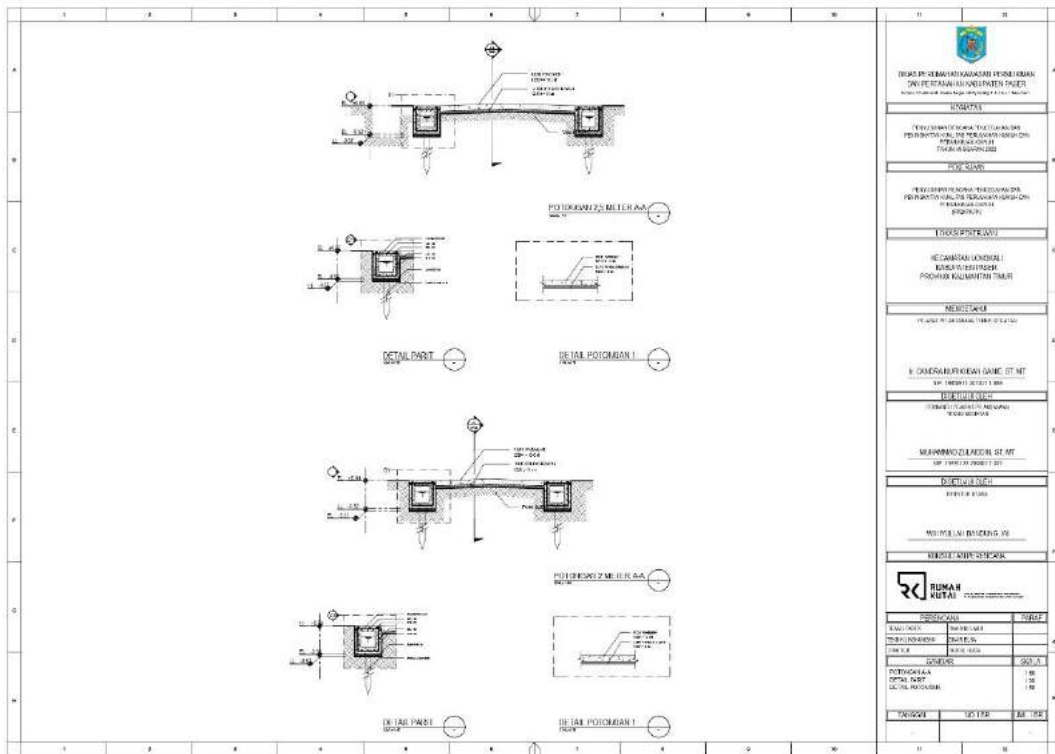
114 Konsep Recana Jalan Segmen 9 RT.16
